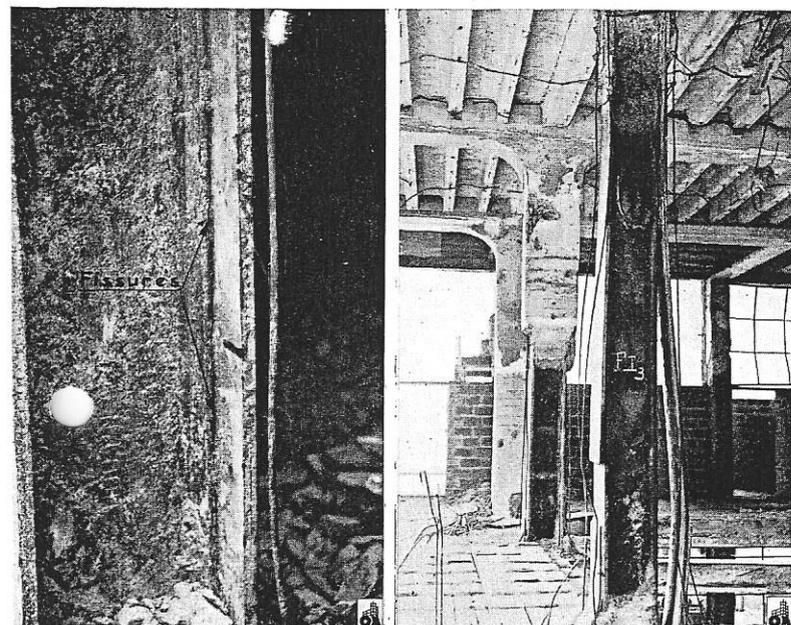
Ferme IV₆, poteau du sous-sol, fissure des cordons fixant la semelle rapportée aux poteaux du profil I. Ferme I₃, poteau kp.
